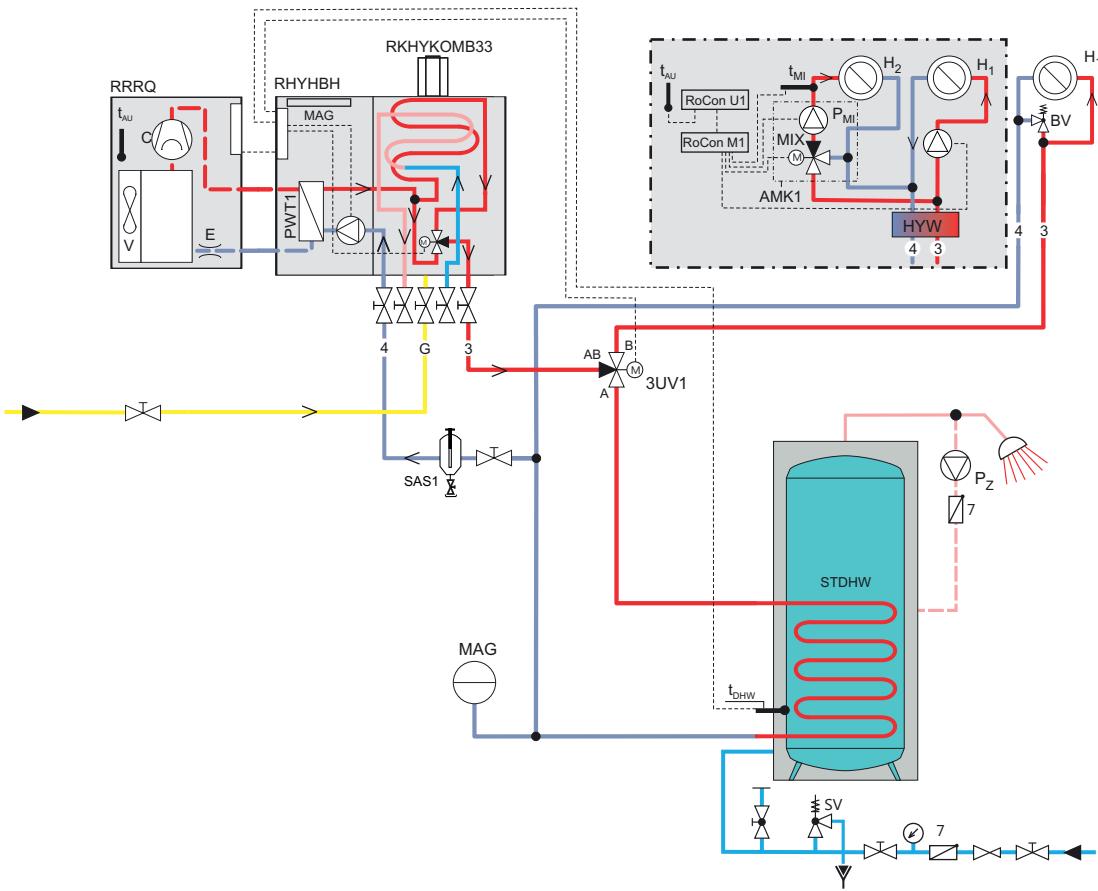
HPU hybrid mit vorhandenem Warmwasserspeicher
